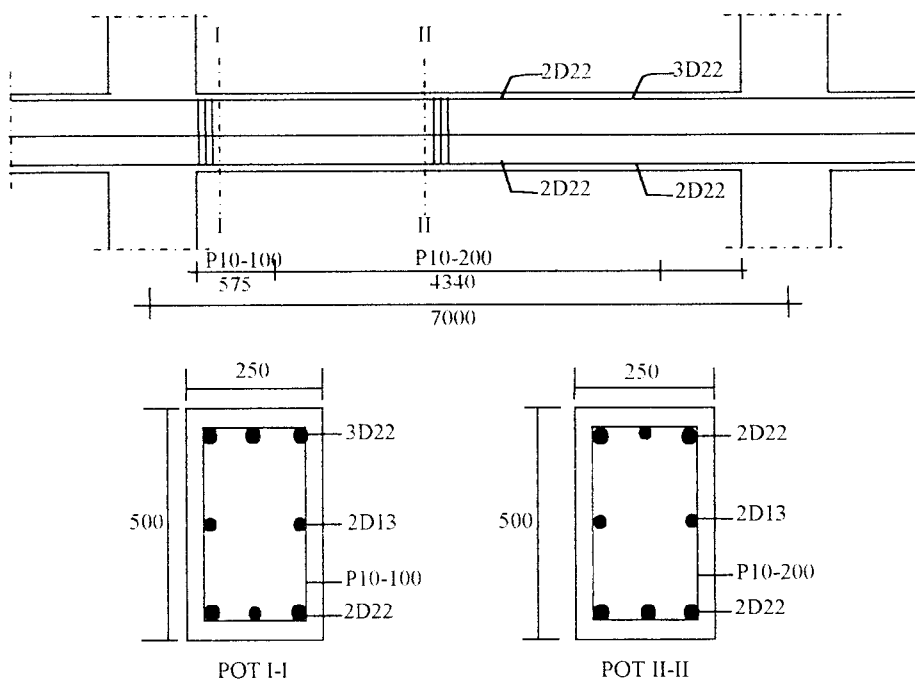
Balok Portal E Bentang 7m Lantai 10
